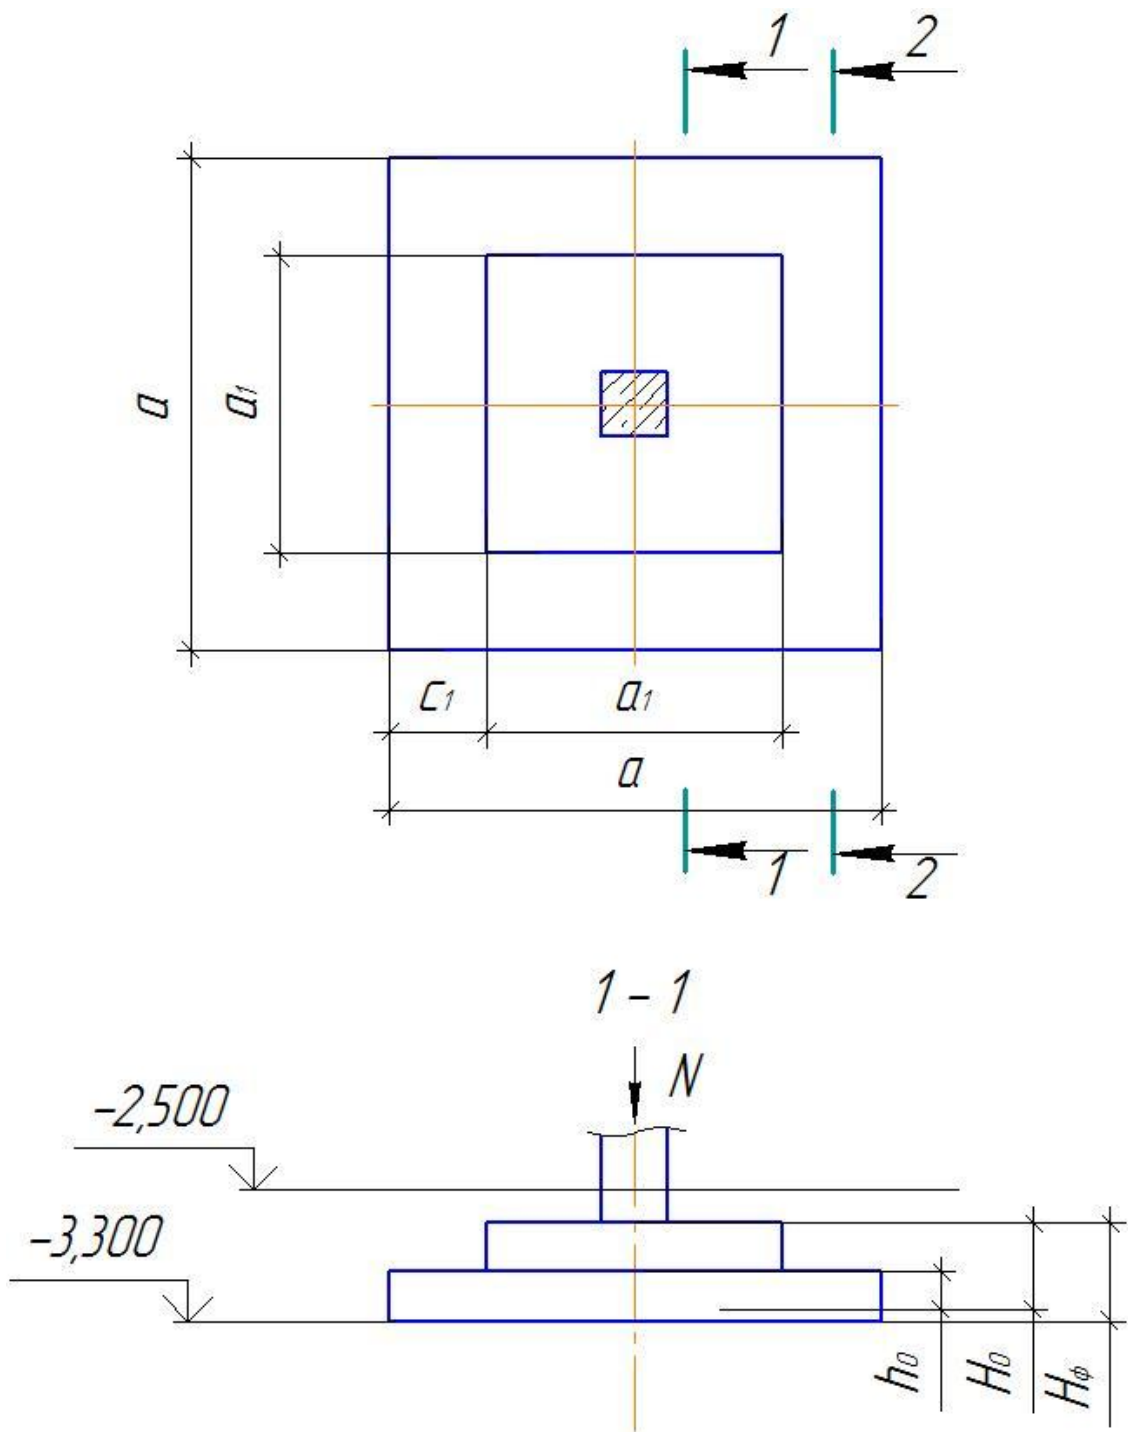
К расчету фундамента разрез А-А и план фундамента
